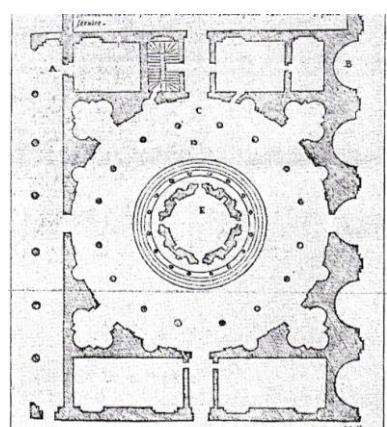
Pátio circular (nunca construído) para o Tempietto de San Pietro in Montório, Roma (Planta)
